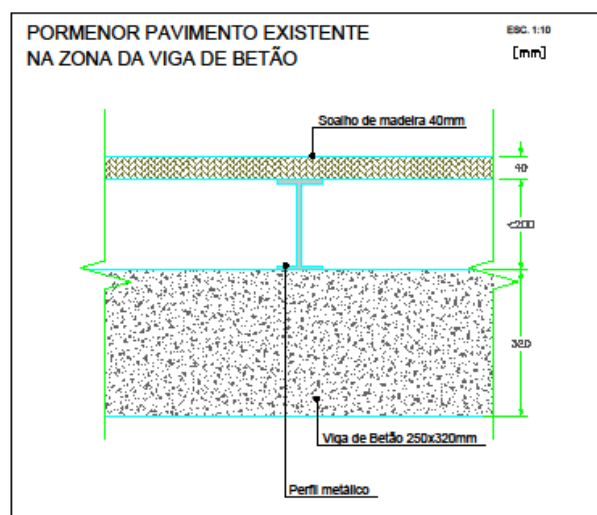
Pormenor do pavimento na zona da viga de betão e do perfil metálico (depois)
